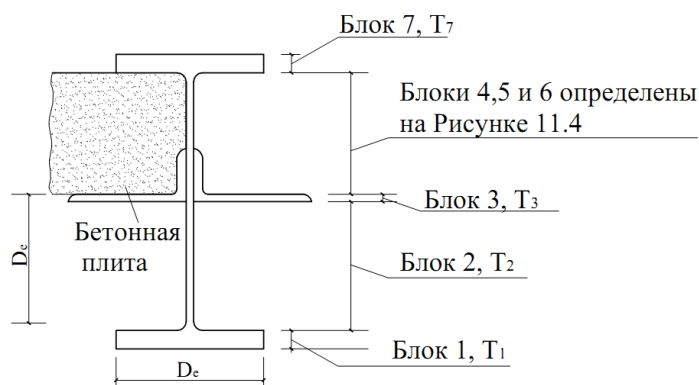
Поперечное сечение балки с опорными уголками
